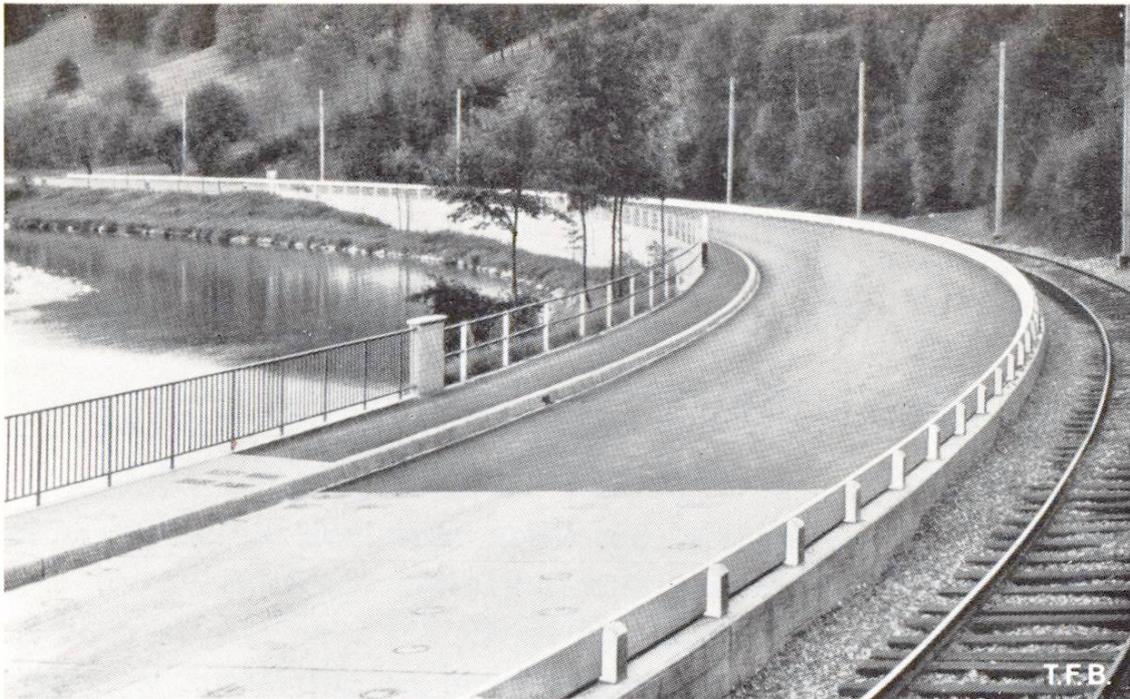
Betonleitschranke aus leicht montierbaren Betonelementen (schweizerisches System)
